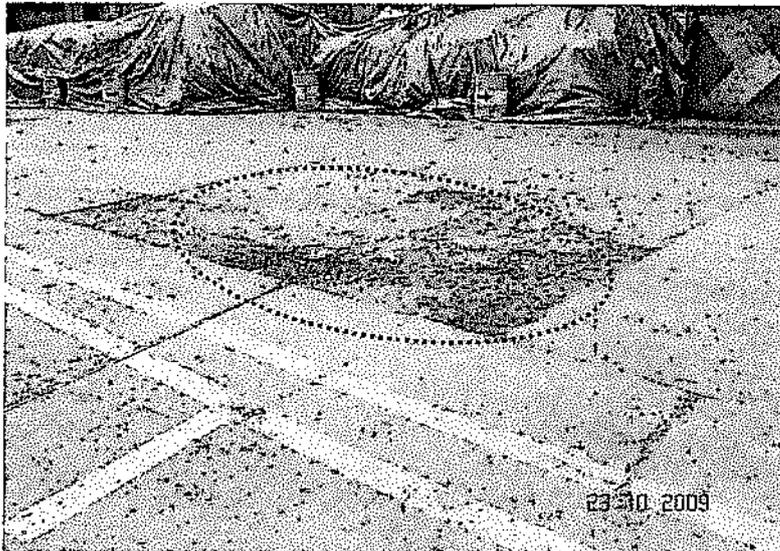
(Obs.1, 2009): Losas deterioradas, en patio de cobre en fado de acceso Av. Atalaya, cercanía a depósito de plomo.
